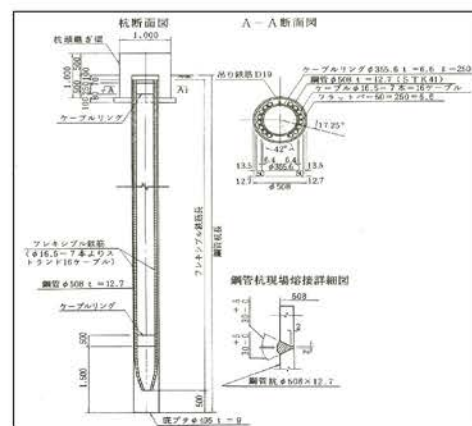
鋼管杭(フレキシブル鉄筋コンクリート杭)
